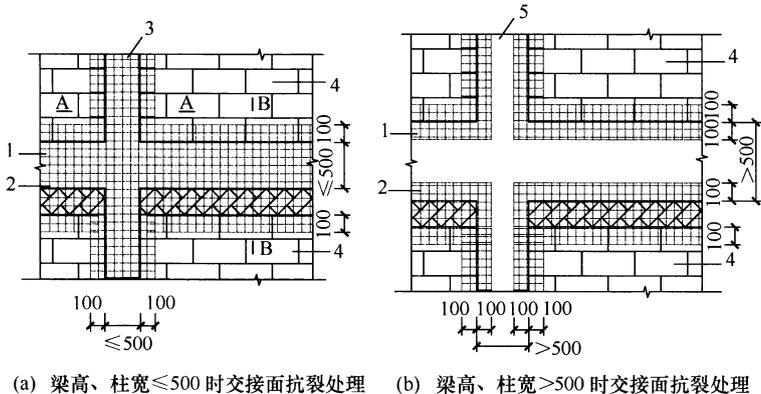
自保温砌块墙体与钢筋混凝土梁、柱、墙交接面抗裂加强处理示意
